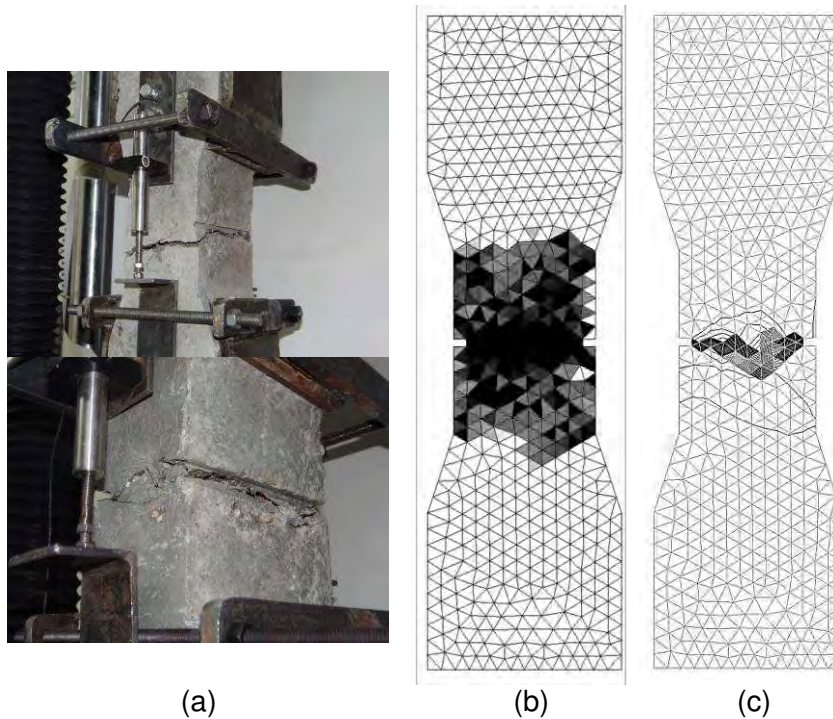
Ensayo de tracción directa, Fisuración avanzada.
